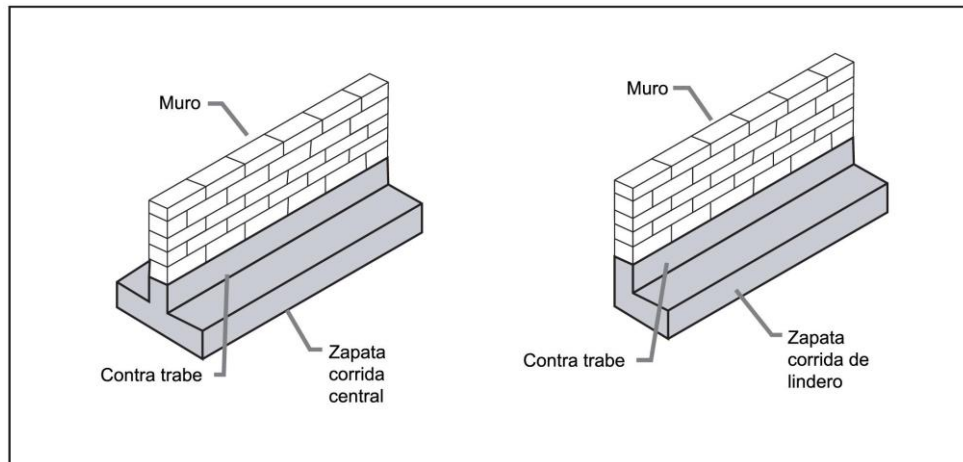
Mampostería. Fuente (ANTAAC, 2016).
